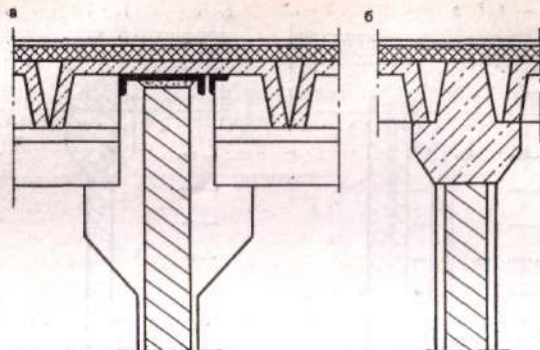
Схемы загрузки колонн в каркасных противопожарных стенах
